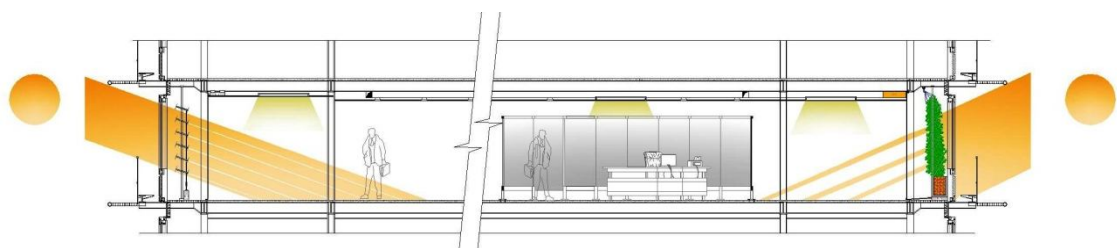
Corte tipo fachada Oeste-Este. Representação da penetração da radiação solar no Inverno nas duas fachadas. Introdução de barreira vegetal na fachada Este e lâminas reguláveis na Oeste. Imagem do autor.
